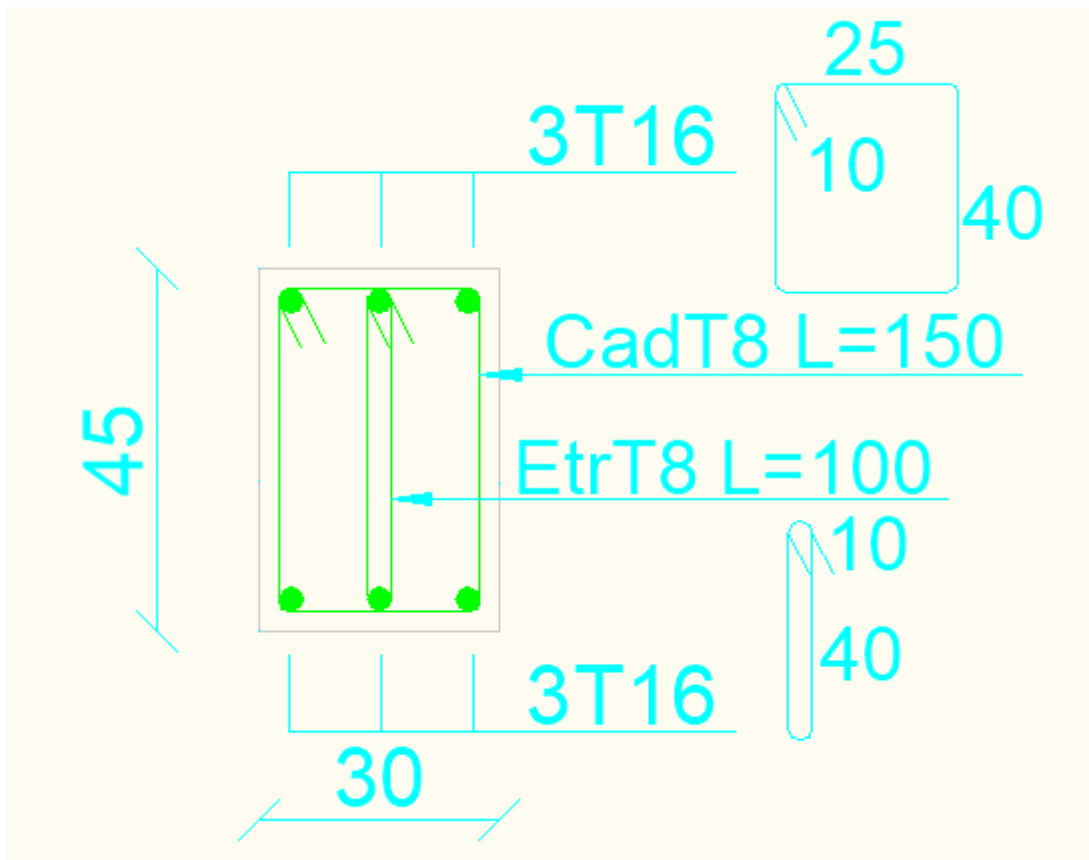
Schéma de ferrailage poutre principale Niv 8 en travée.
